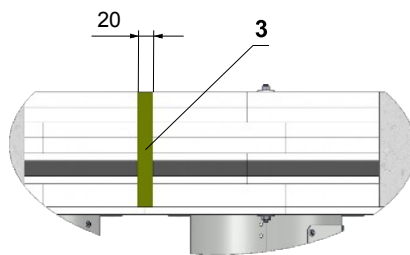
Massivdecken - Trockeneinbau - Flansch an Flansch - Einbaurahmen
